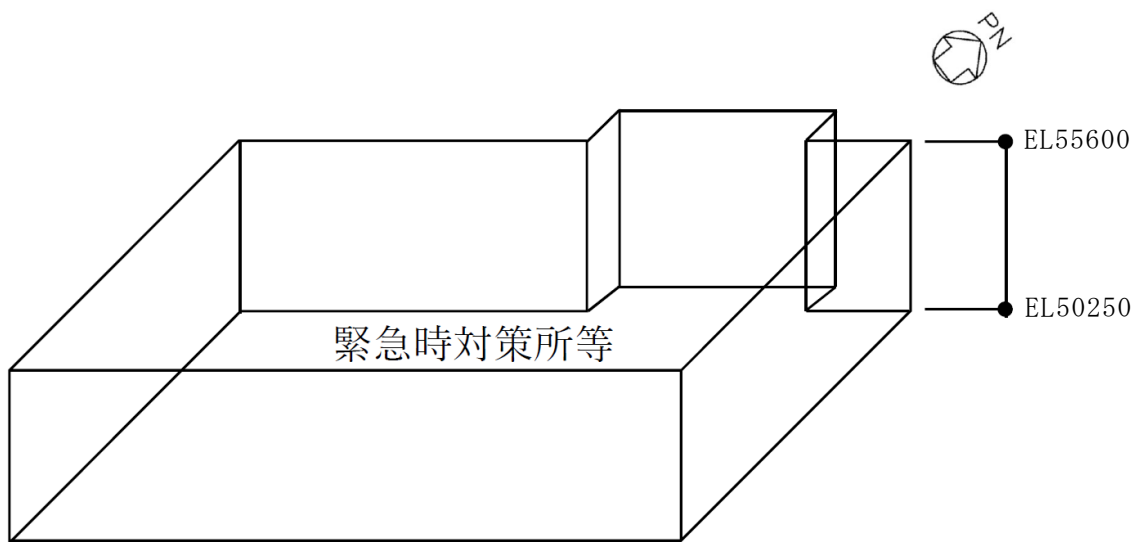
(2) 緊急時対策所遮蔽の概略断面図（B - B 断面，EW 方向）
